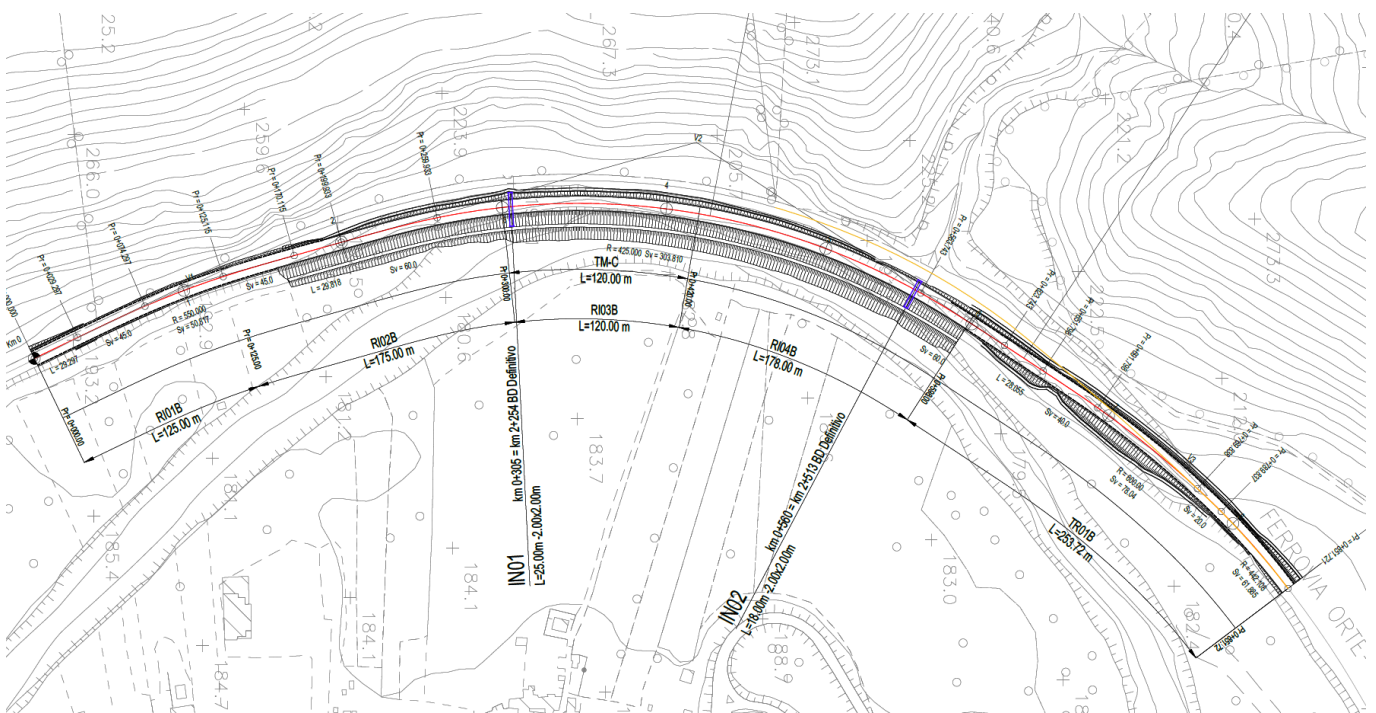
Deviato provvisoria “*Cascatelle*” della linea storica: stralcio della planimetria di progetto.
